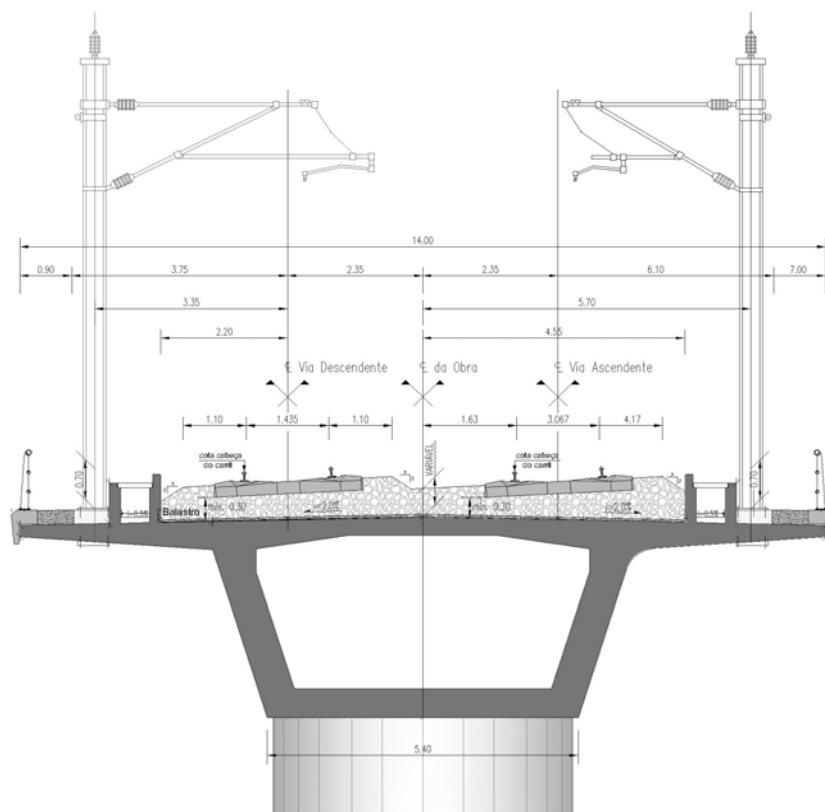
Secção transversal tipo de via dupla em Pontes e Viadutos
